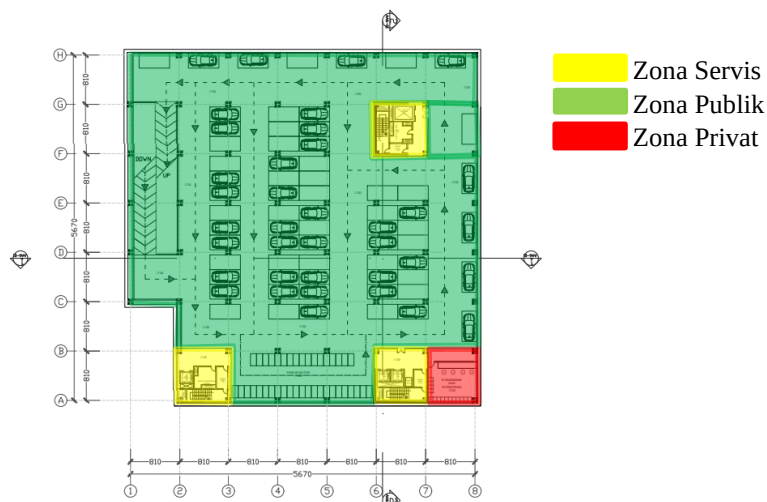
Zoning dan sirkulasi lantai 7-8 apartemen
